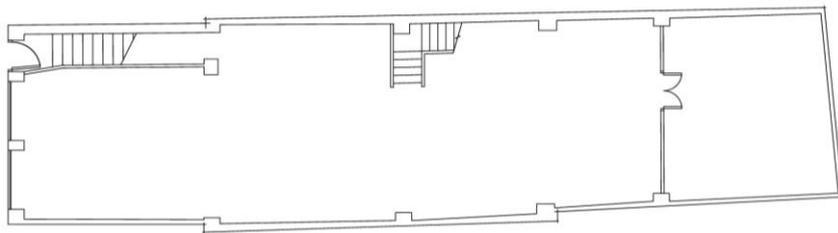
Plano distribución de planta baja. 2018. Fuente: Propia
